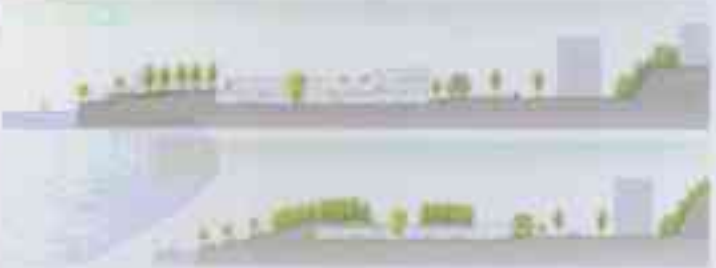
调整后的草场门—定淮门段剖面示意
